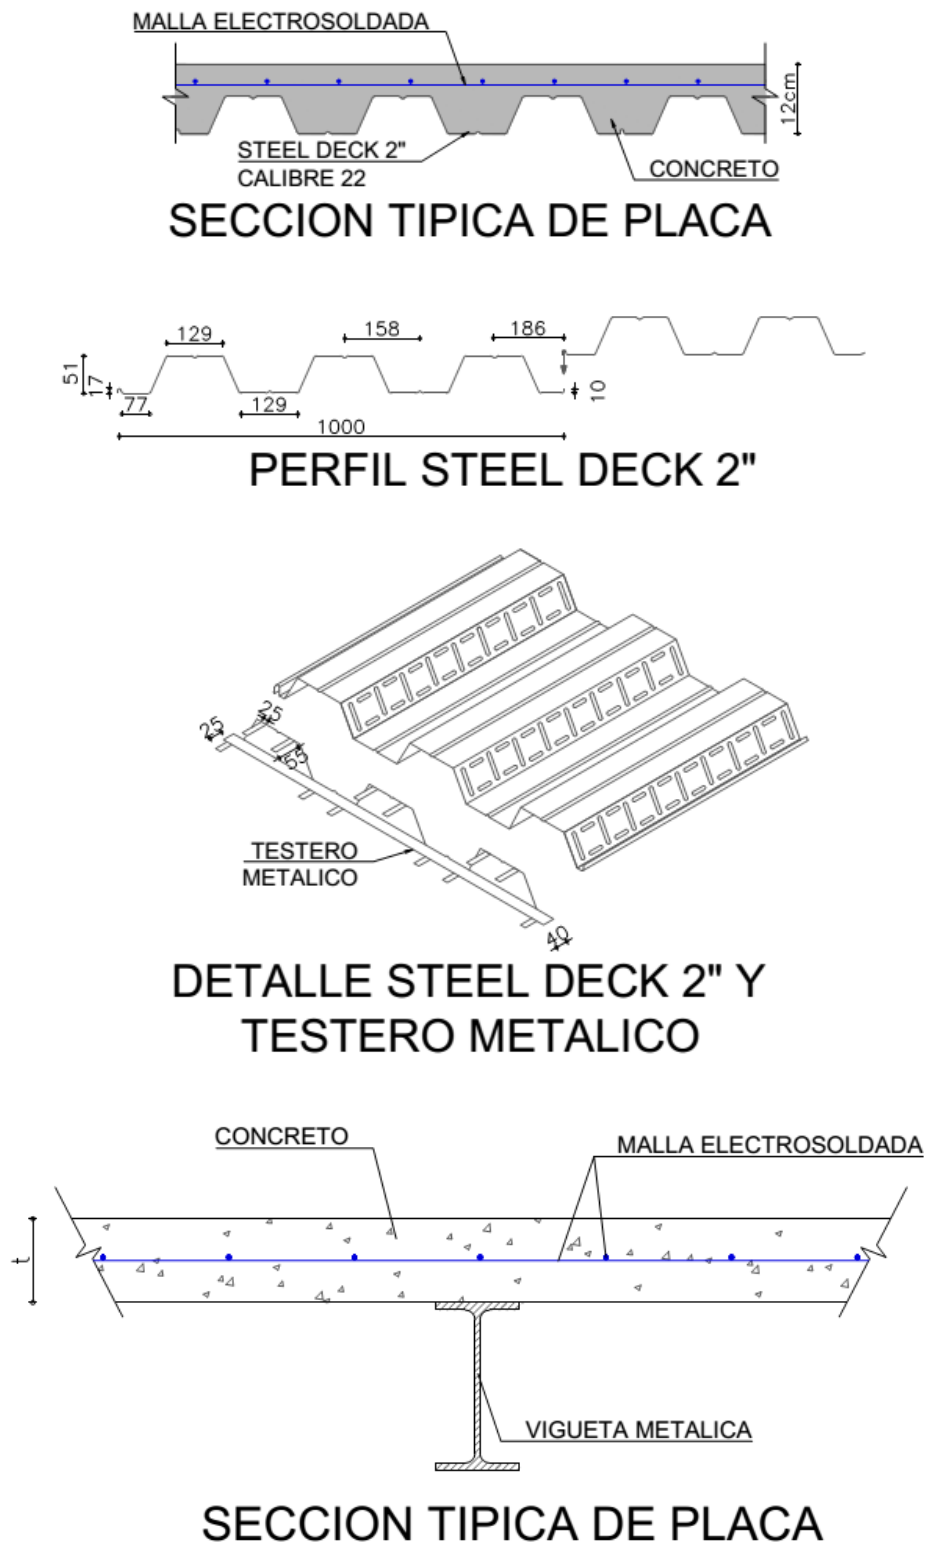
Sección típica de placa en Steeldeck para modelamiento.
